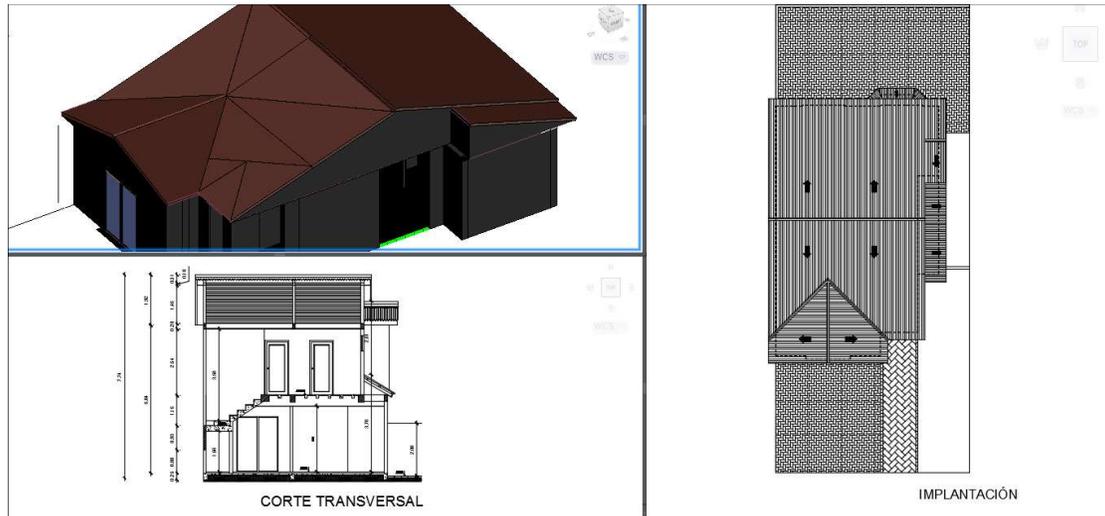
Representación de Cubierta en planta, corte y 3D del sistema tradicional
